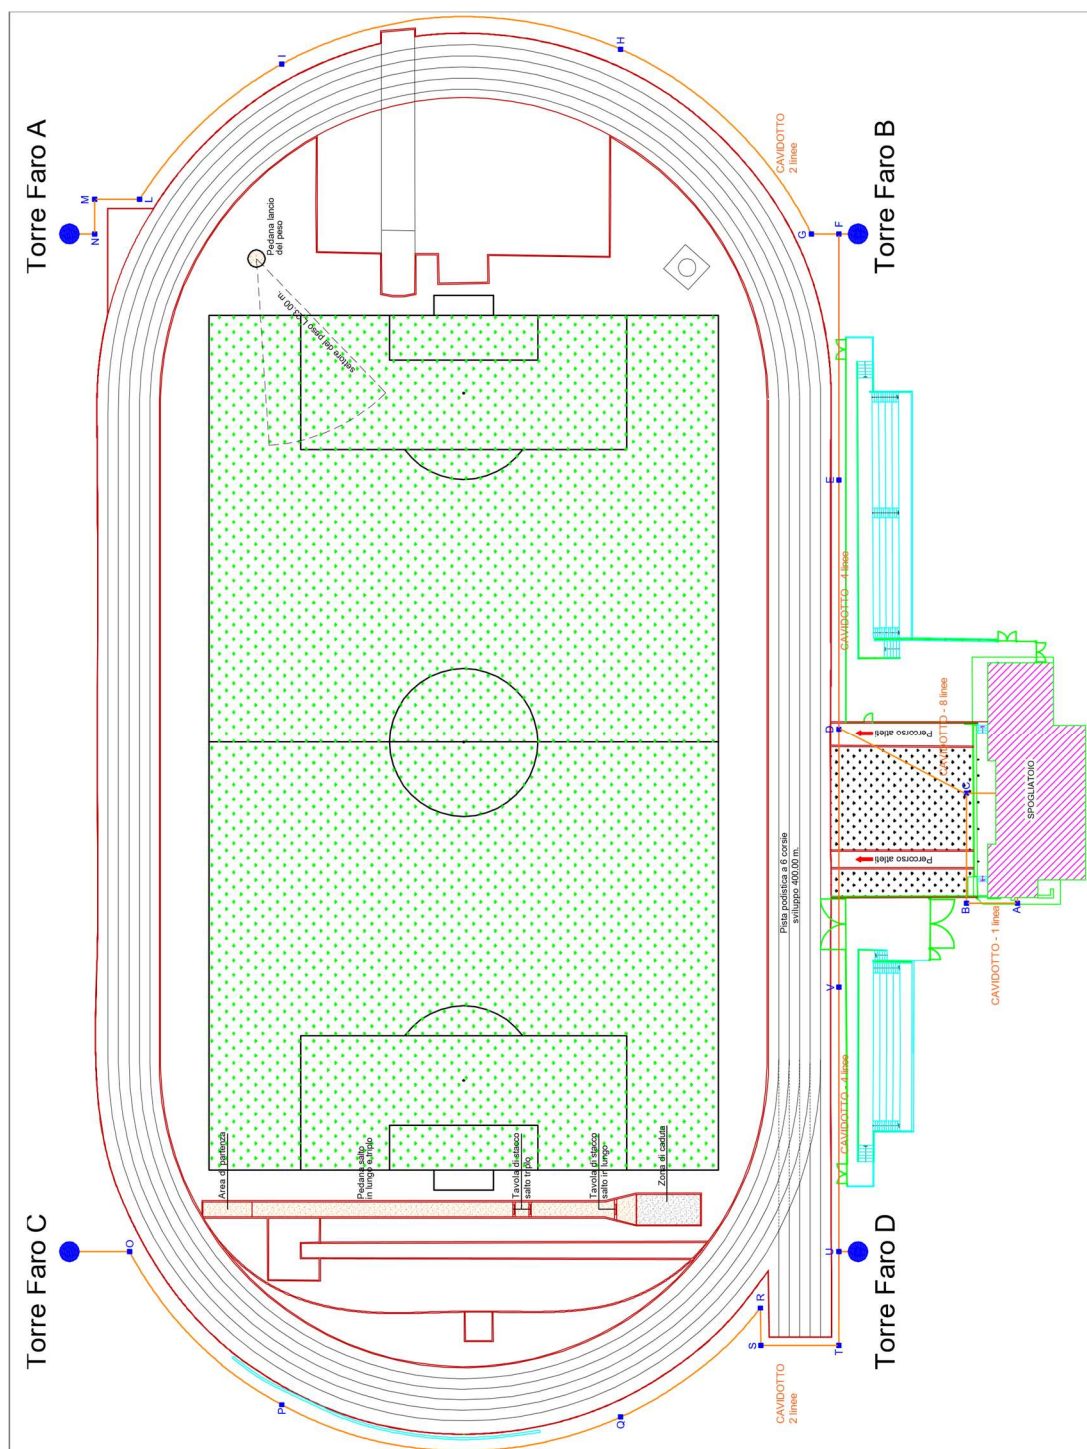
Planimetria dell'intero impianto sportivo di via Pulliere con indicazione dei pozzetti di ispezione, dell'andamento del cavidotto e della posizione delle torri faro
